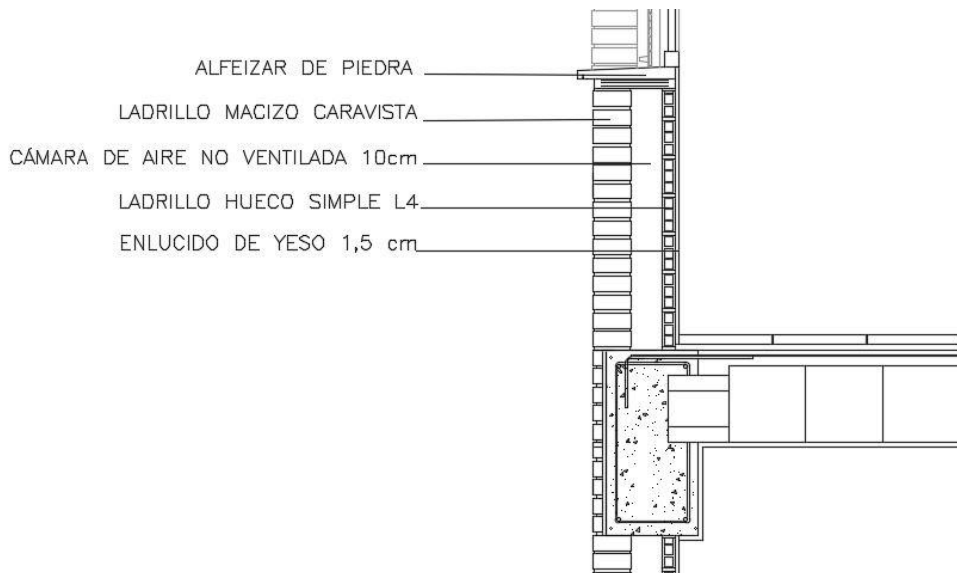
Detalle constructivo de la fachada del grupo Federico Mayo. Fuente: Elaboración propia
